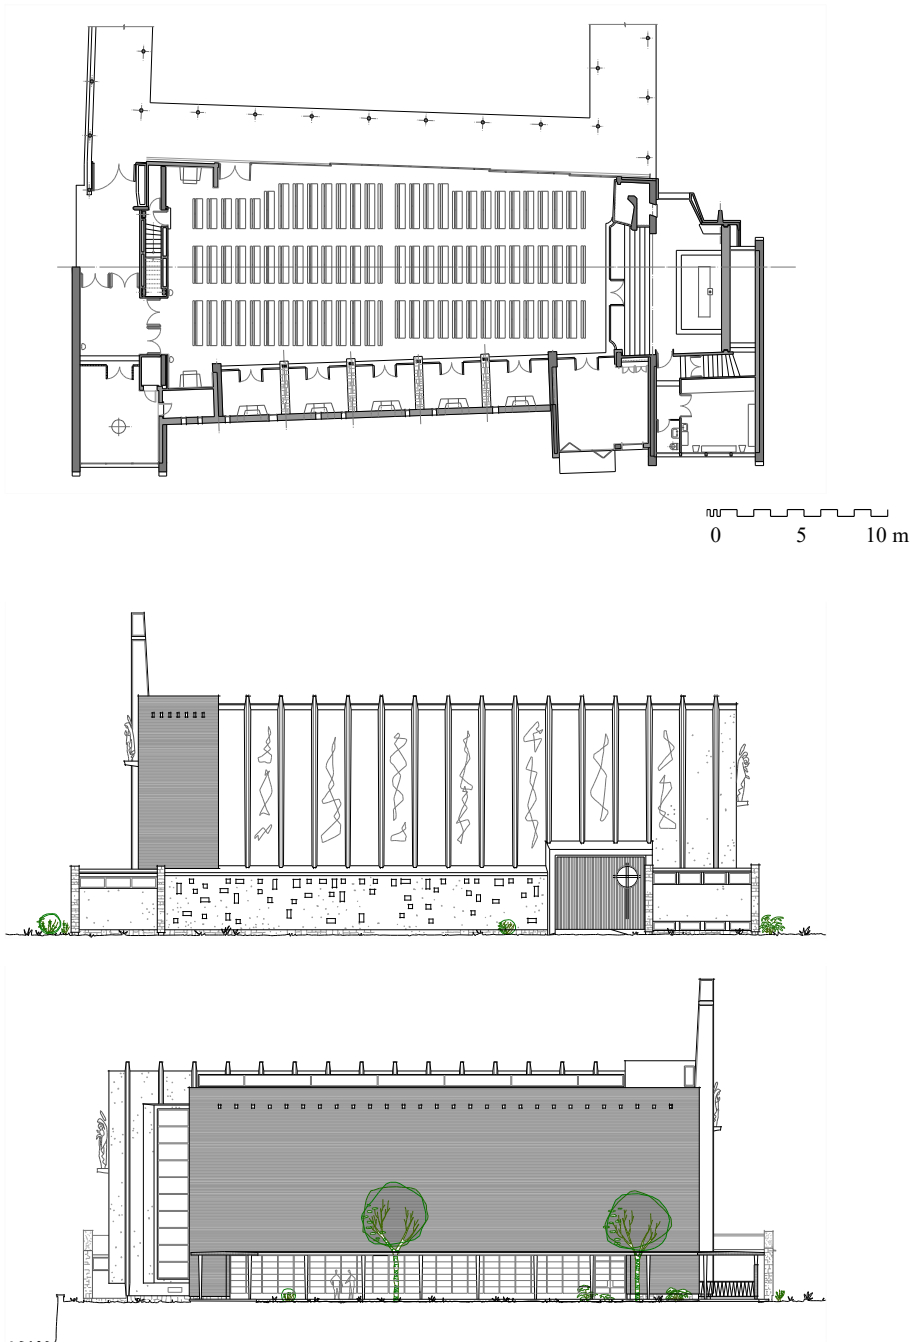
Planta y alzado sur (arriba) y norte.
